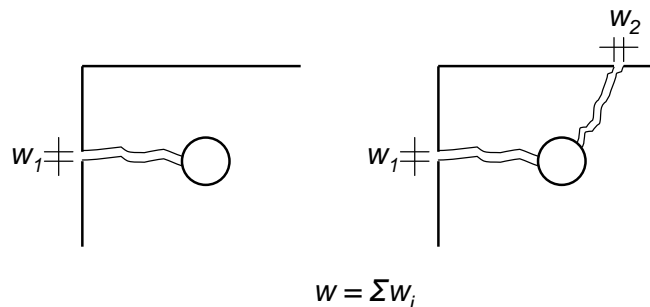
Bewehrungsstab in Ecklage mit möglichen Rissbildern und der Aufsummierung der Rissbreiten
